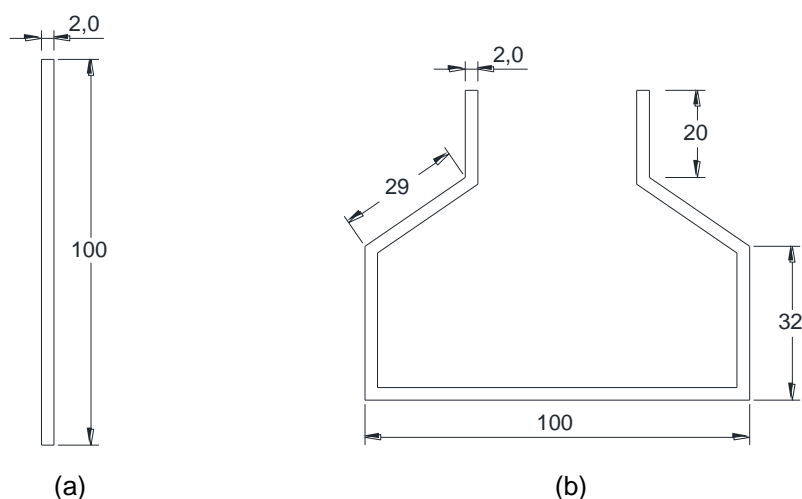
Dimensões da seção transversal (mm): (a) Placa; (b) Perfil rack
